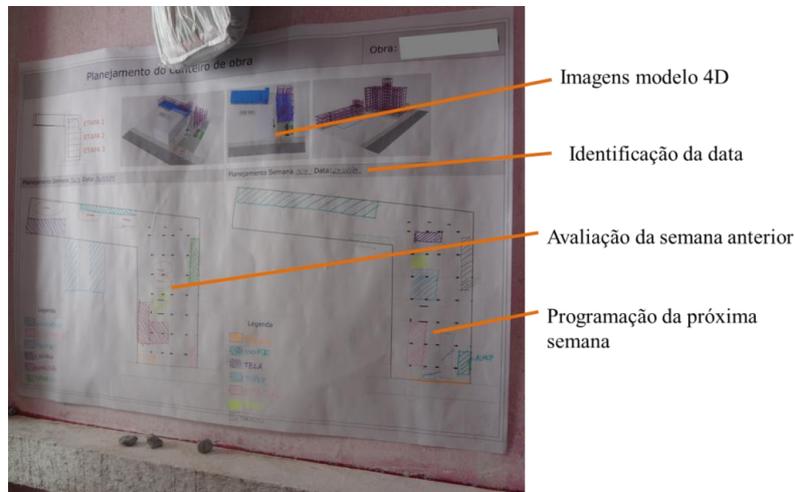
Painel para planejamento e replanejamento da logística do canteiro.
